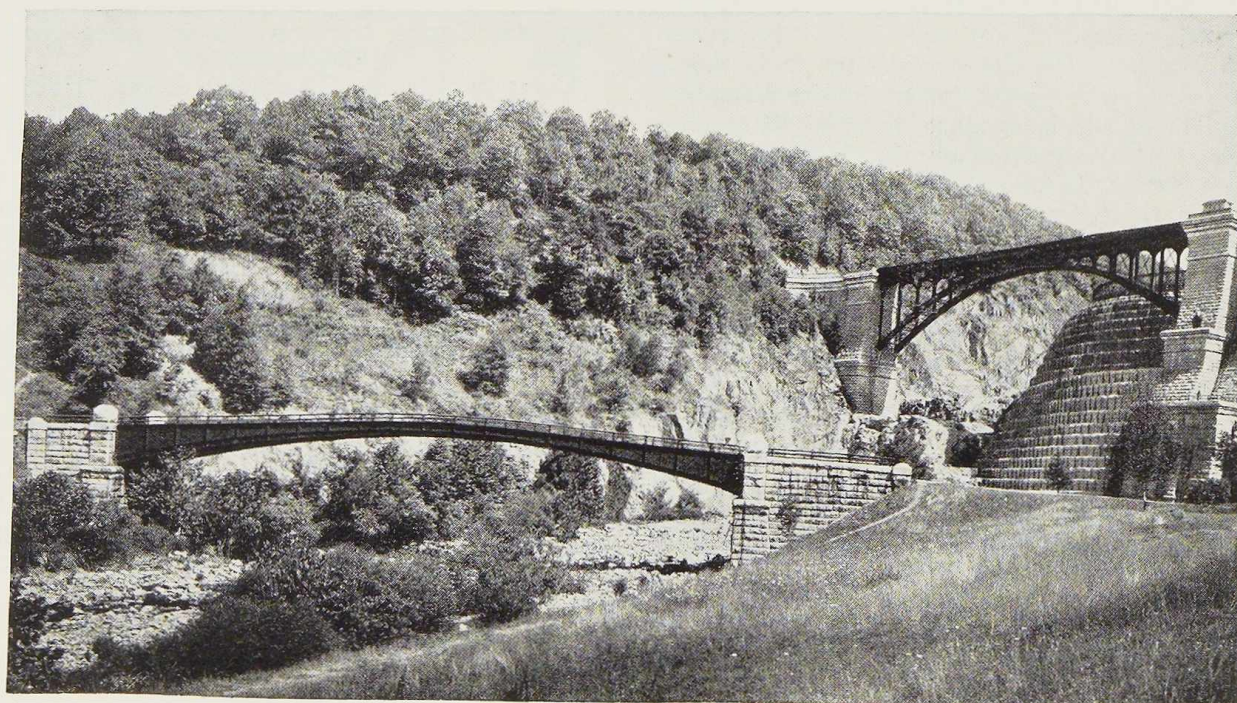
Ponts-routes en arc construits en 1904 au barrage Croton (New-York).
